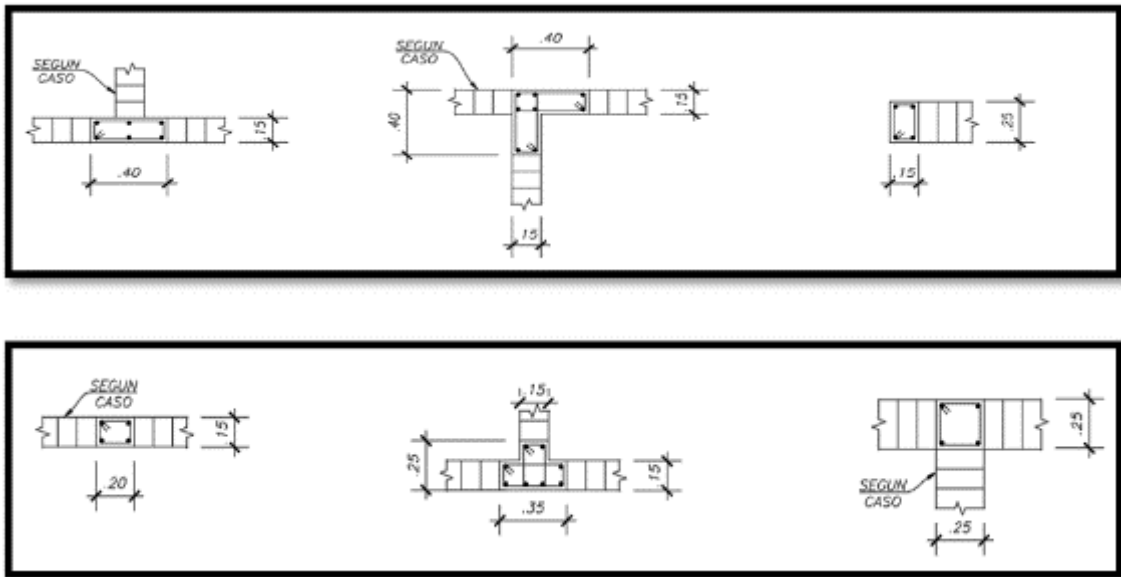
Secciones de columnas de arrioste a emplear en vivienda sismorresistente
